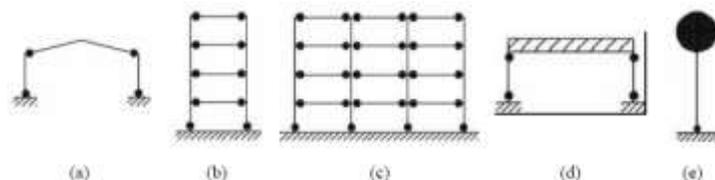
Configurazioni dissipative di strutture intelaiate: disposizione delle cerniere plastiche, secondo le tipologie esposte nella Tabella 7.3.II del § 7.3.1 delle NTC
